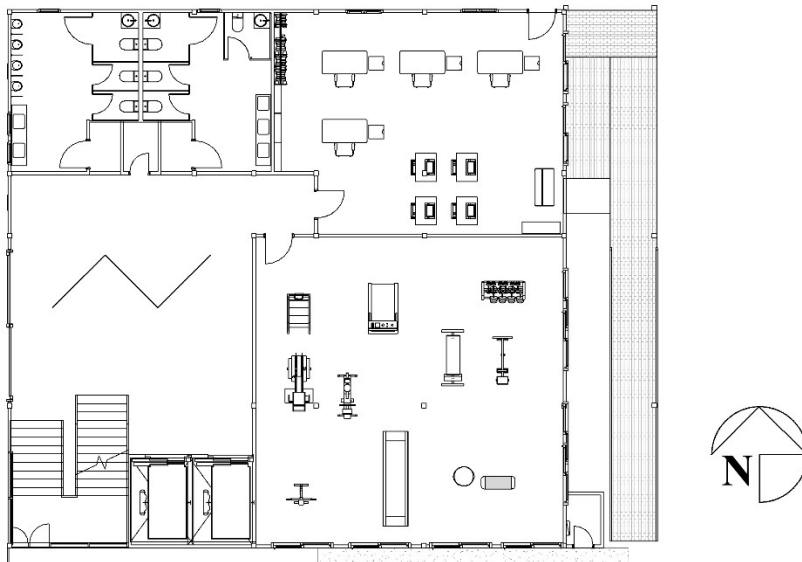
Planta Edificio 1, nivel 1, Zona 2, sin escala.
